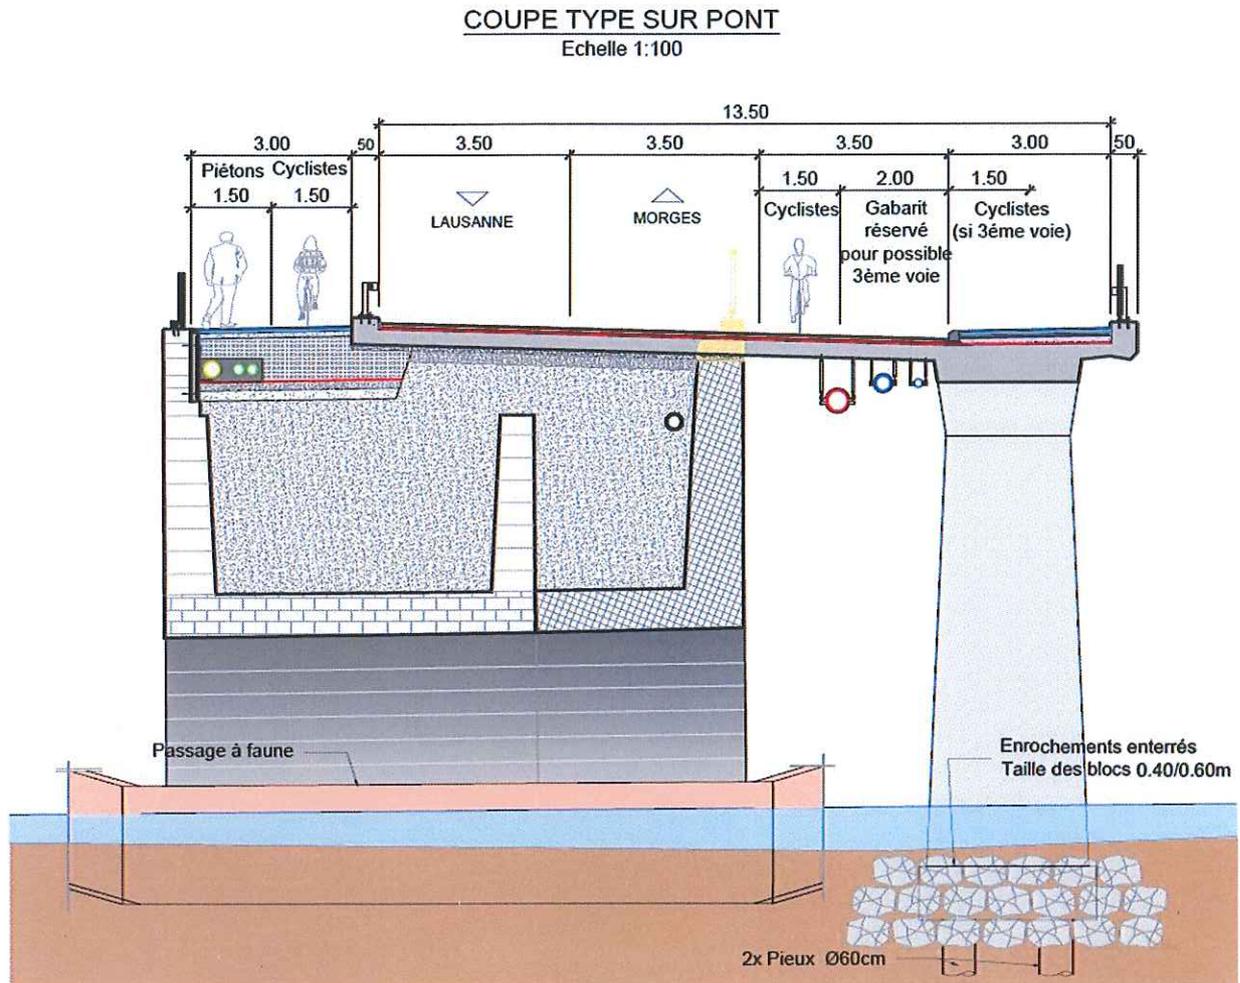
élargissement du pont sur la Venoge (profil en travers).
